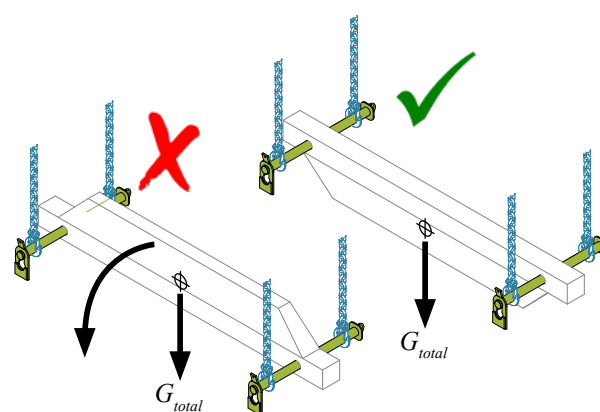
Posizionamento del punto di sollevamento rispetto al baricentro di una trave.
